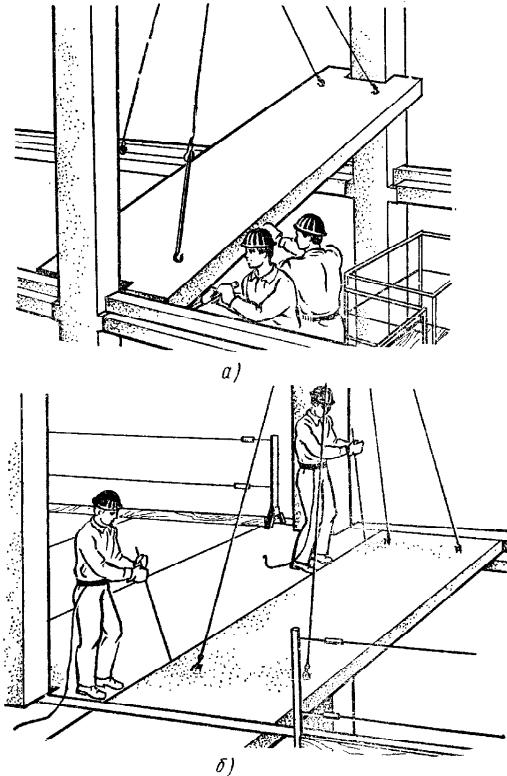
Монтаж плит перекрытия в каркасном здании:
